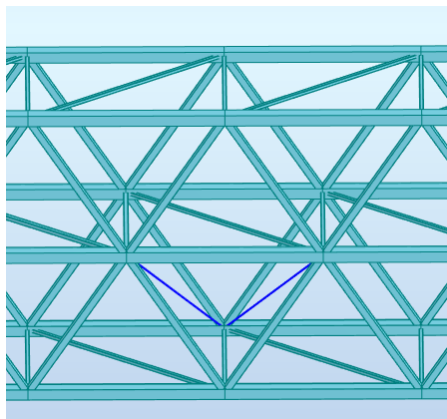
Barras de contraventamento (cor azul escura) aplicadas na nova configuração da ponte provisória
